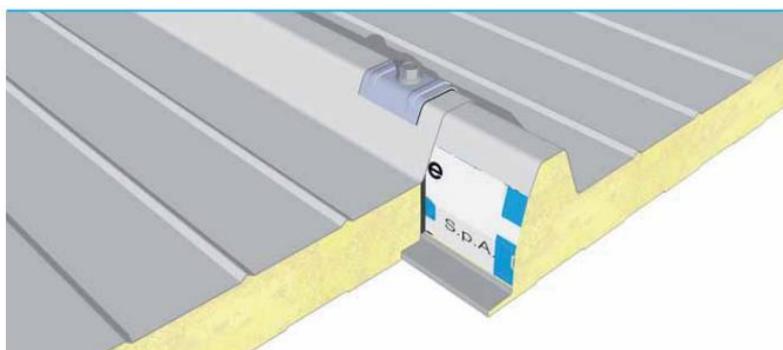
Detalle de panel Sándwich. Fuente Panel Sándwich Madrid
